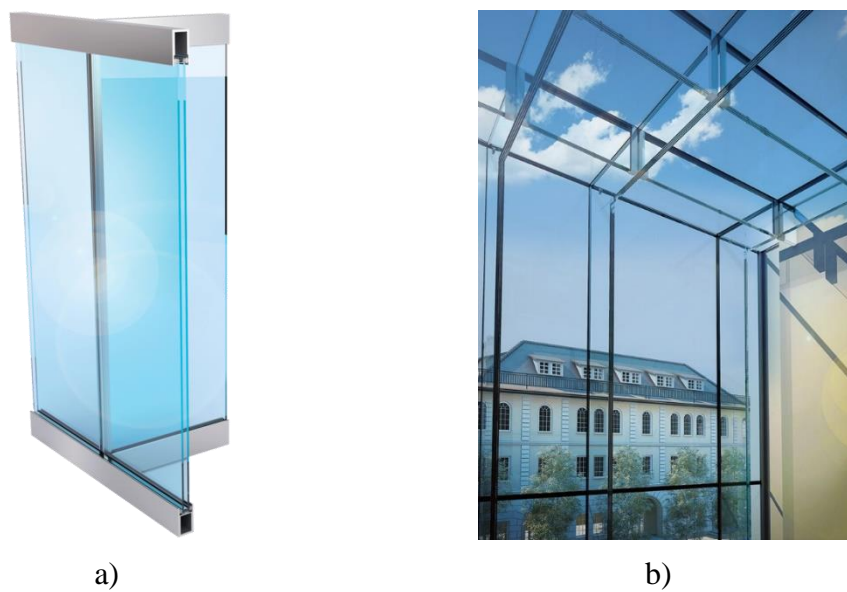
a) Sistema de fixação das fachadas (Oldcastle BuildingEnvelope, s.d.); b) Sistema de ligação entre painéis de fachada e *glass fins* e painéis de pavimento/ cobertura e vigas (GLASSCON GmbH, s.d.)
